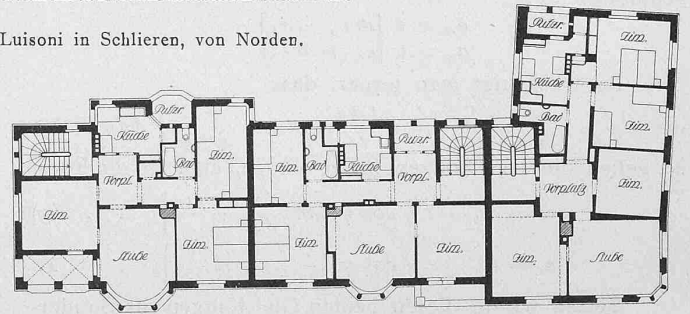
u. 2. Grundrisse der Beamtenhäuser in Schlieren. — 1 : 400.
